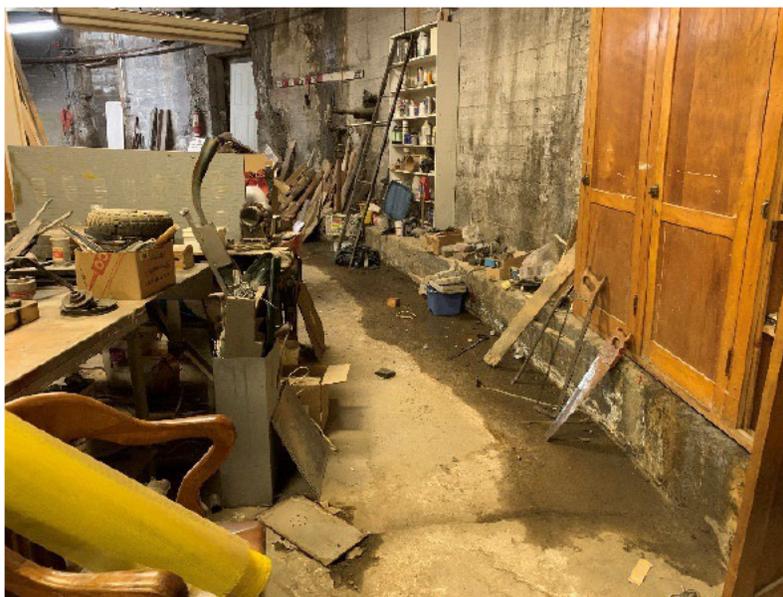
Humidité à la base d'un mur et trace d'efflorescence
